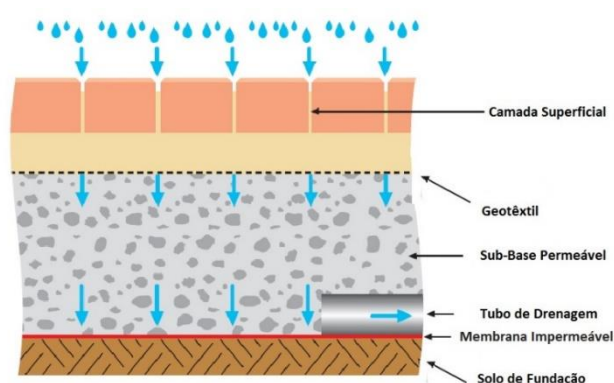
Sistema sem infiltração (adaptado de Interpave, 2010)
